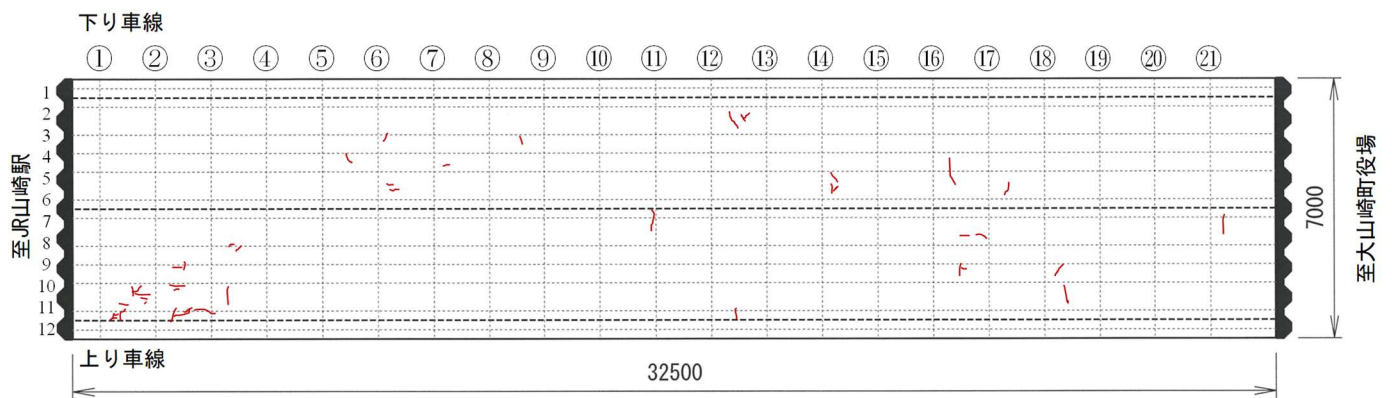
供用3ヶ月ひび割れ図 (2016年12月)
